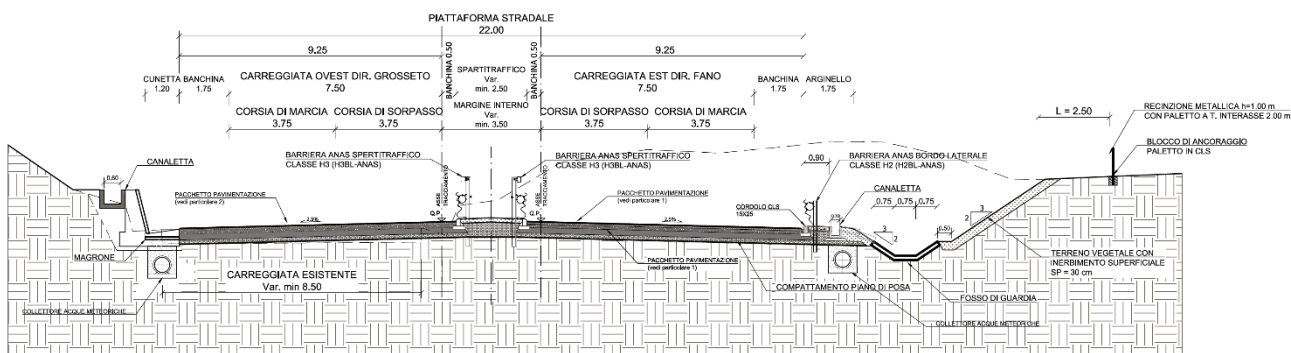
Sezione tipo in trincea in rettilineo con scavo laterale e muro a margine
